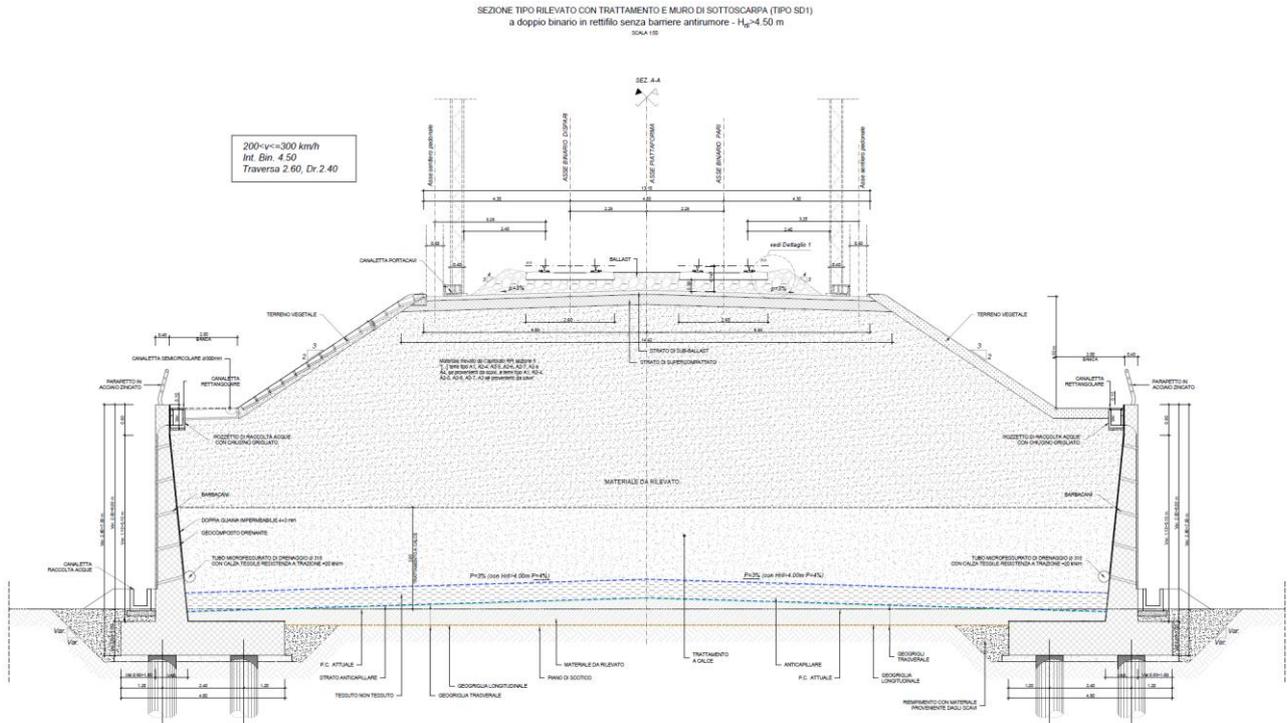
Sezione tipo in rilevato con muro di sottoscarpa (tipo SD1) a doppio binario $H_{tr} > 4.50$ m
